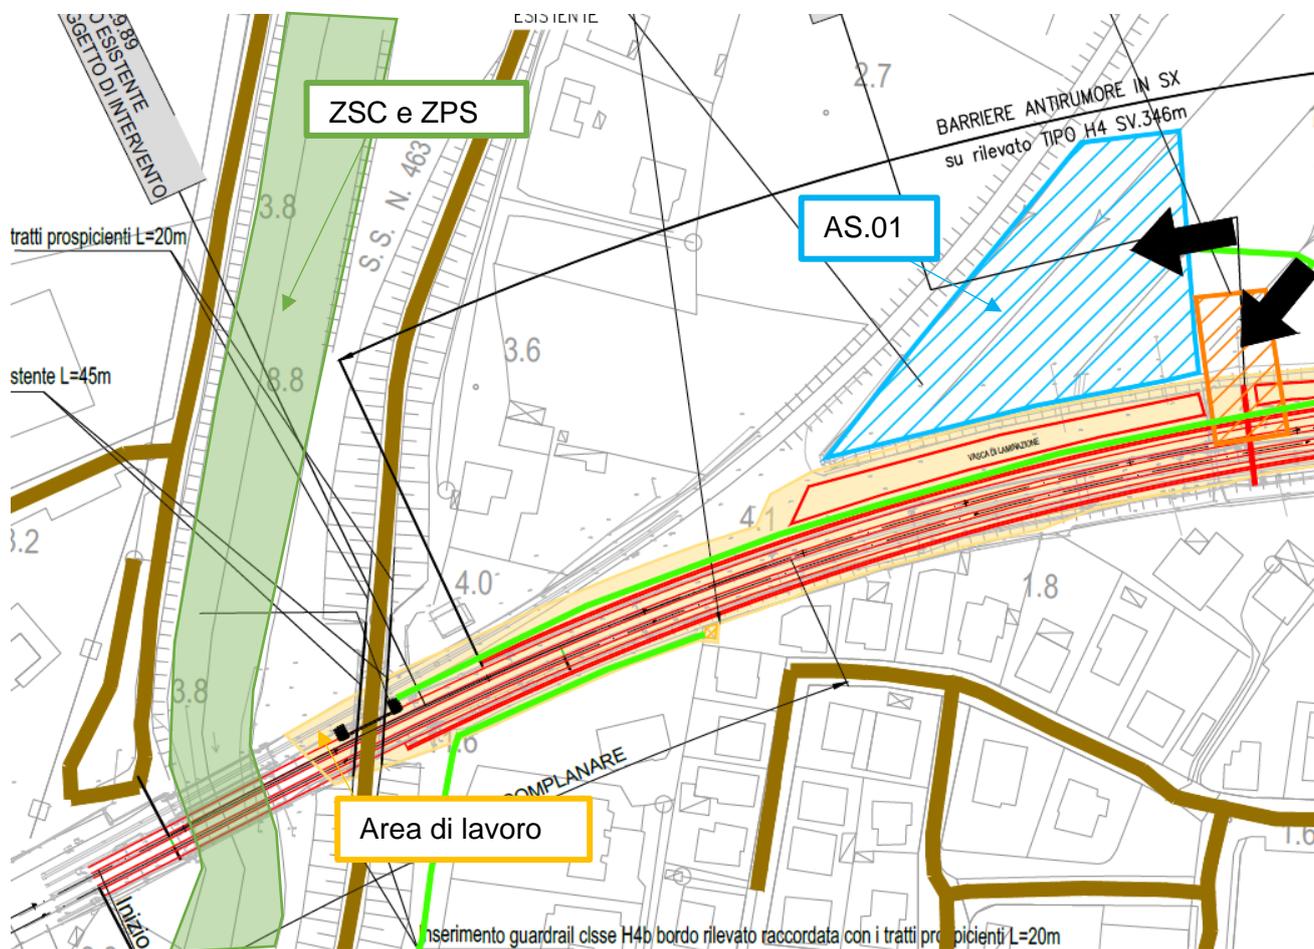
Stralcio Planimetria di Cantierizzazione prevista per la realizzazione della Variante di Portogruaro
